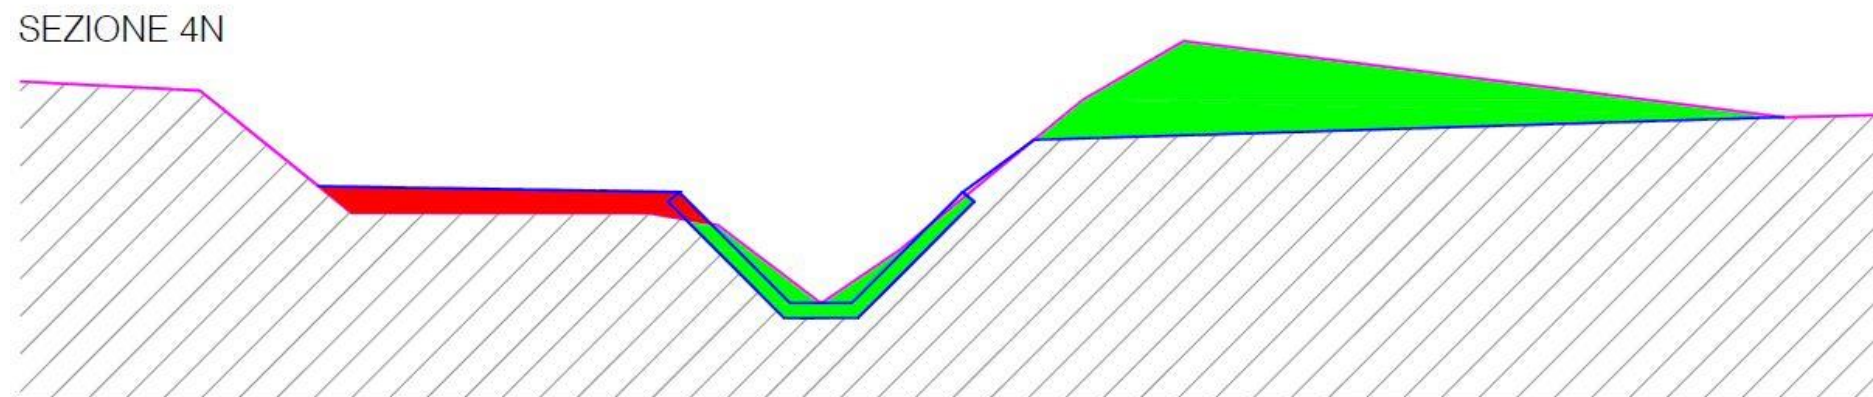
Prima sezione oggetto d'intervento, sovrapposizione tra la sezione esistente e quella di progetto
